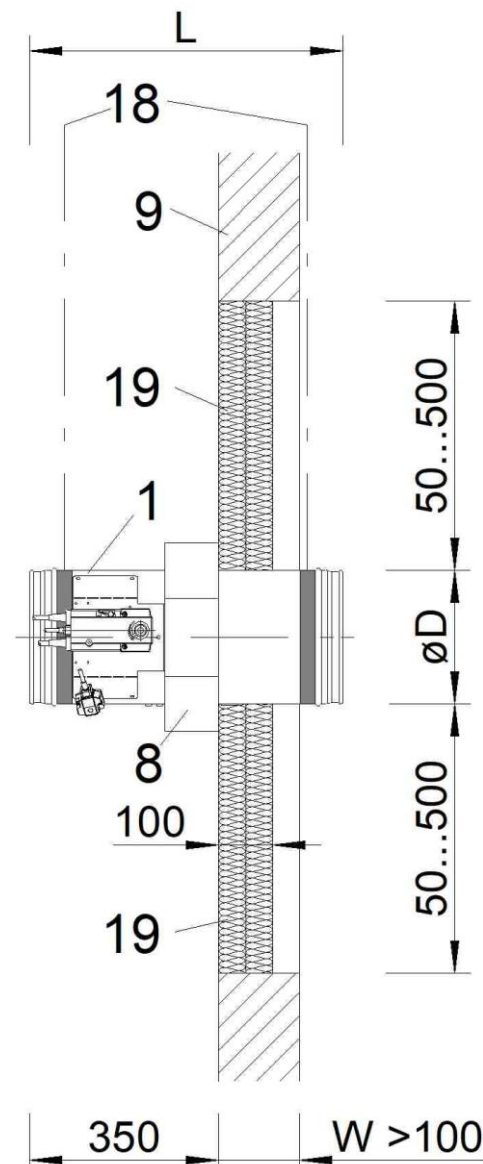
montaggio in parete massiccia (spessore parete > 100 mm)
